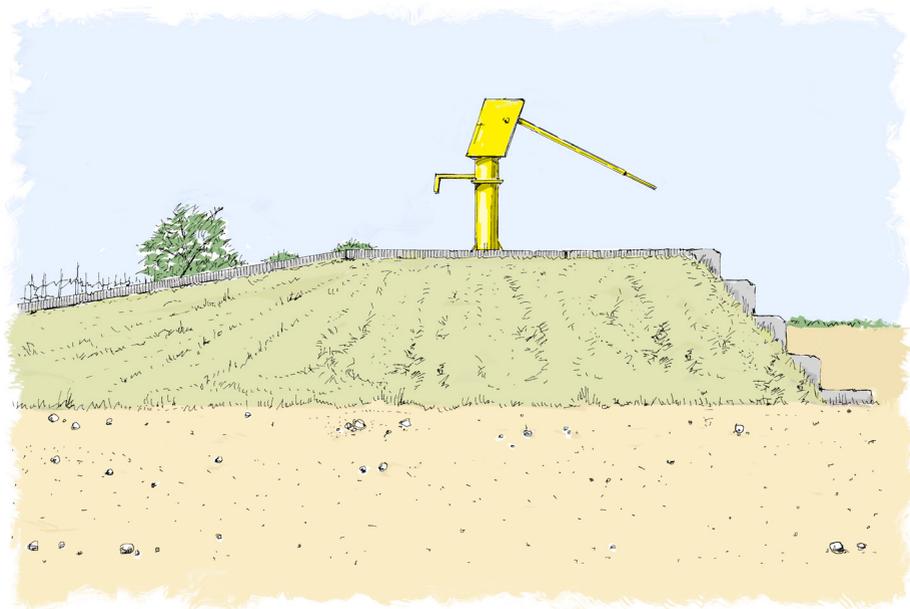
Dalle surélevée et canal pour zones plates ou inclinées
